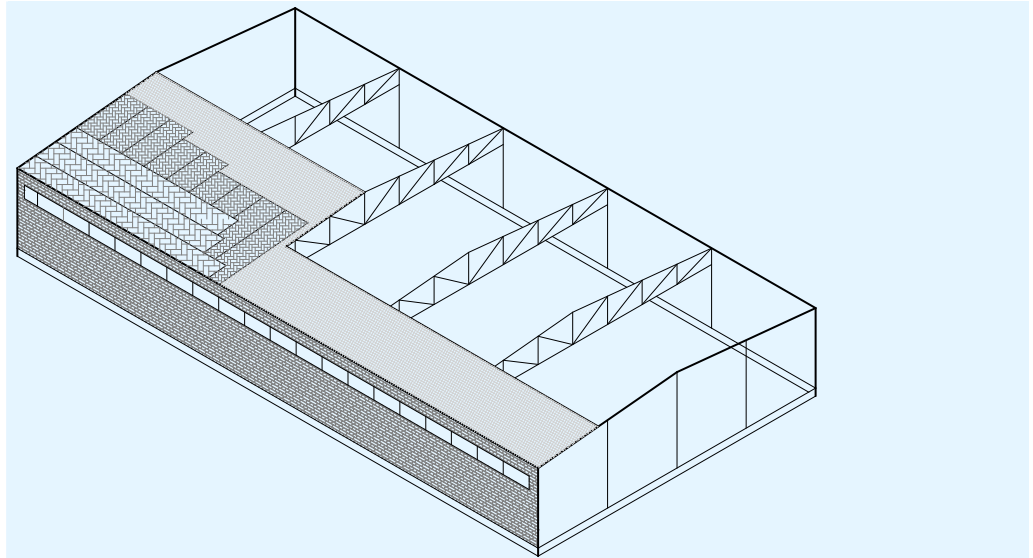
Estructura compuesta por cerchas planas rígidas (tipo Pratt)
